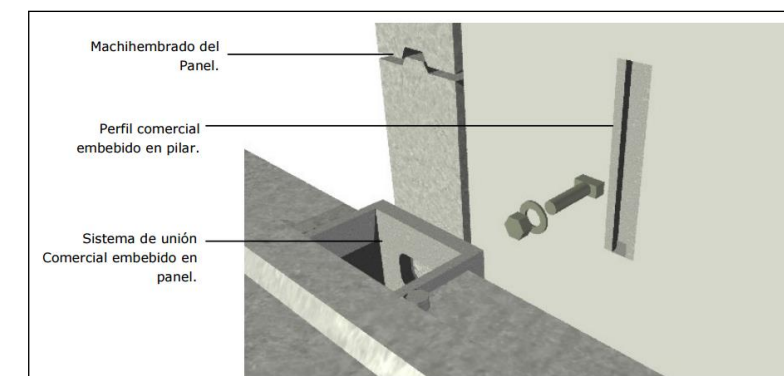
b. Anclaje del cerramiento a los pilares. Fuente: catálogo técnico PACADAR
